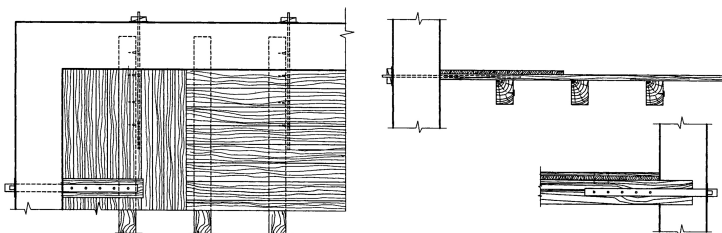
b – Ancoraggio con piatti d'acciaio del solaio ligneo alle murature perimetrali
